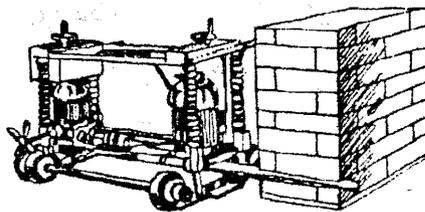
Máquina corta muros de Edil-Comer de Bagnolo in Piano
